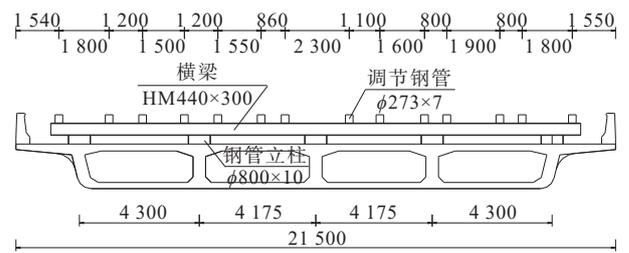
钢箱梁拼装支架横断面布置图(单位:mm)
